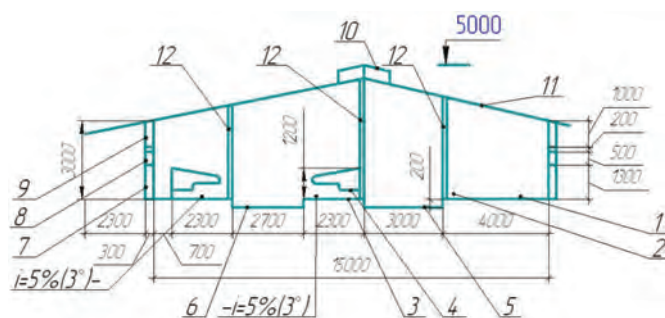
Сімейна молочна ферма для утримання 15 корів (фасад)
